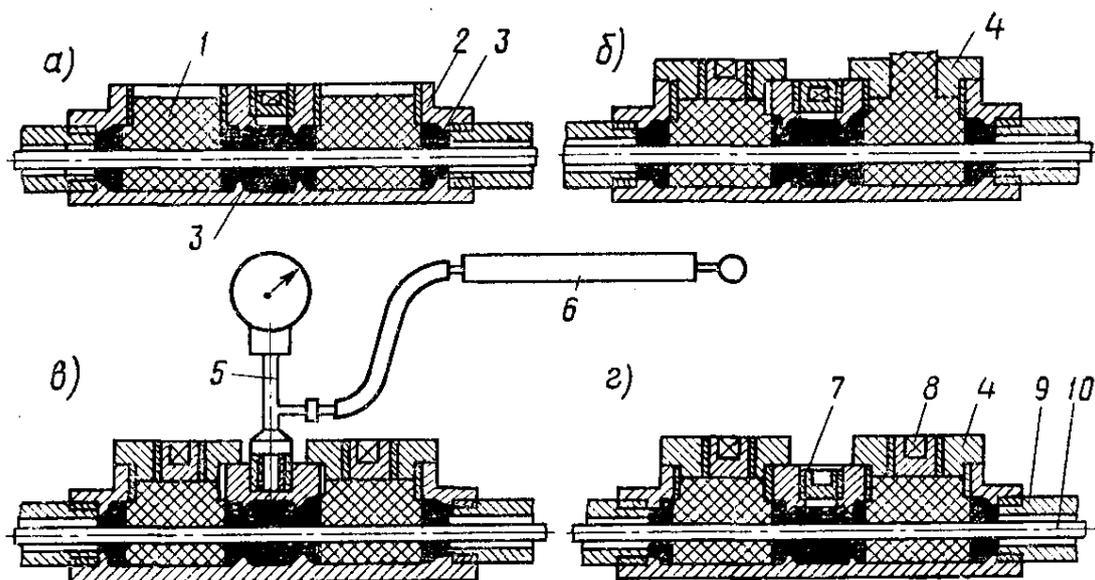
Разделительное уплотнение в коробке КПЛ: а, б, в, г - процессы монтажа и испытания уплотнительного разделения; 1 - уплотнительный состав УС-65; 2 - корпус; 3 - набивка из асбестового шнура; 4 - крышка; 5 - приспособление для испытания разделительных уплотнений в коробках КПЛ; 6 - насос; 7,8 - пробки; 9 - трубопровод; 10 - кабель или провод
